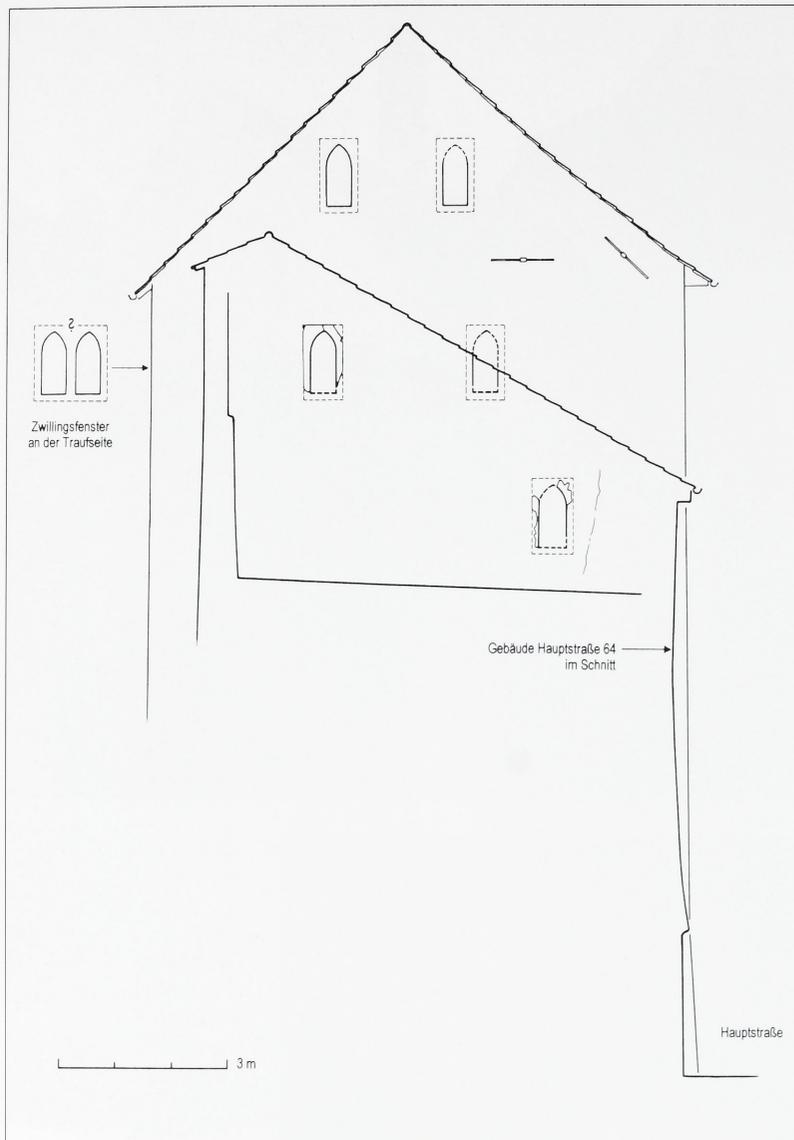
Rottweil, Hauptstraße 62. Ansicht der östlichen Giebelseite mit den im Dachraum des Nachbarhauses verborgenen Fensteröffnungen. Die Fensterfaschen sind rekonstruierend eingestrichelt.
